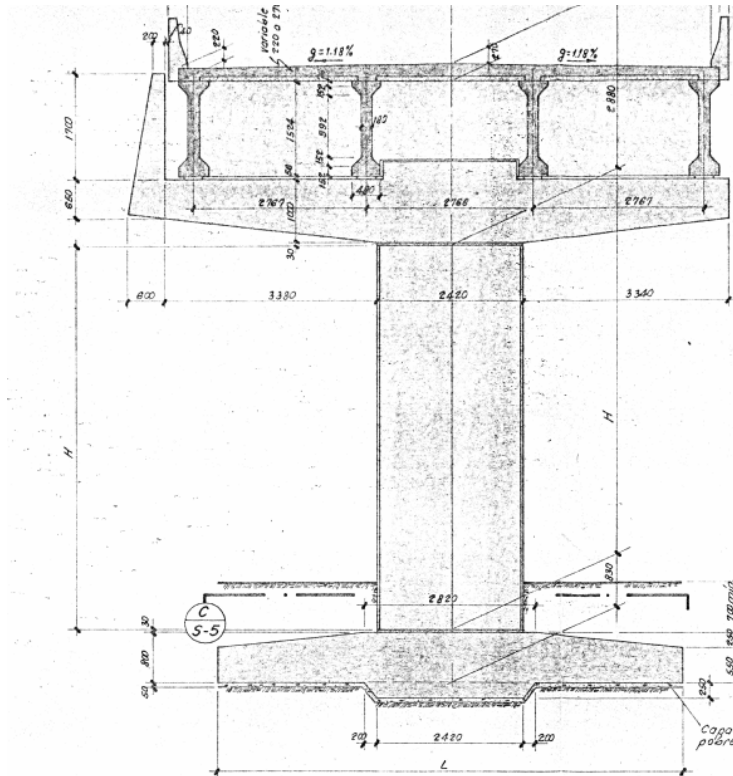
Detalle de Fundaciones en Pilas Prefabricadas
